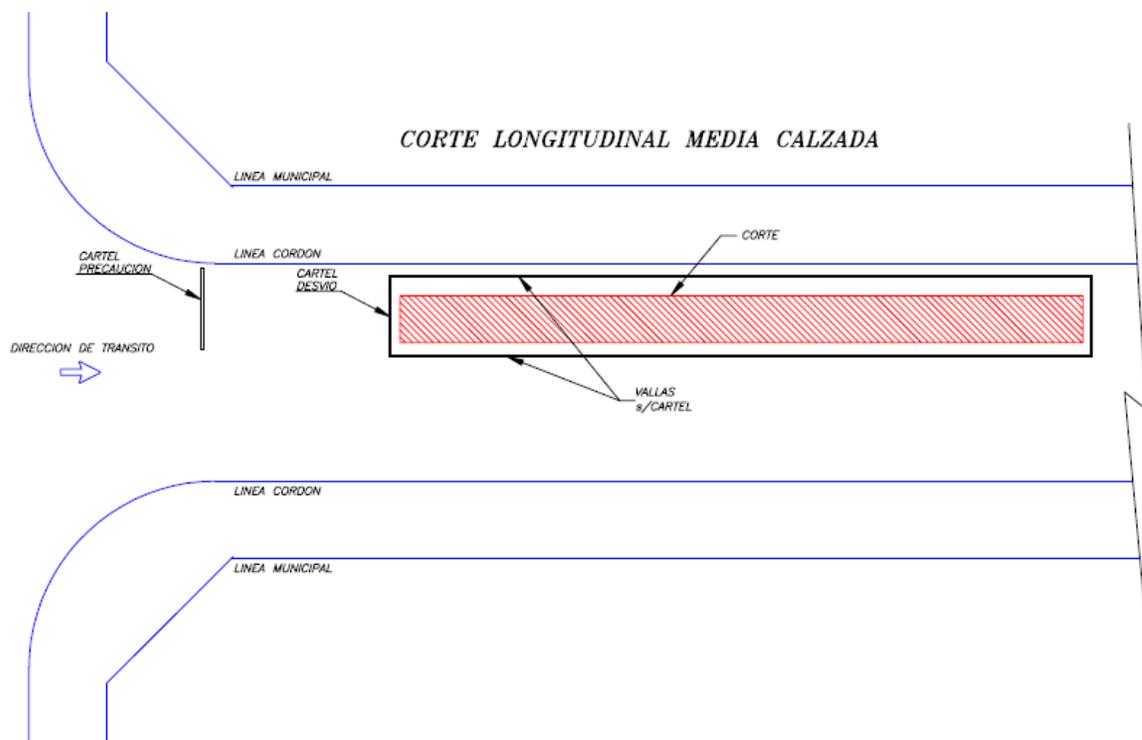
Esquema en planta de un corte de media calzada.
